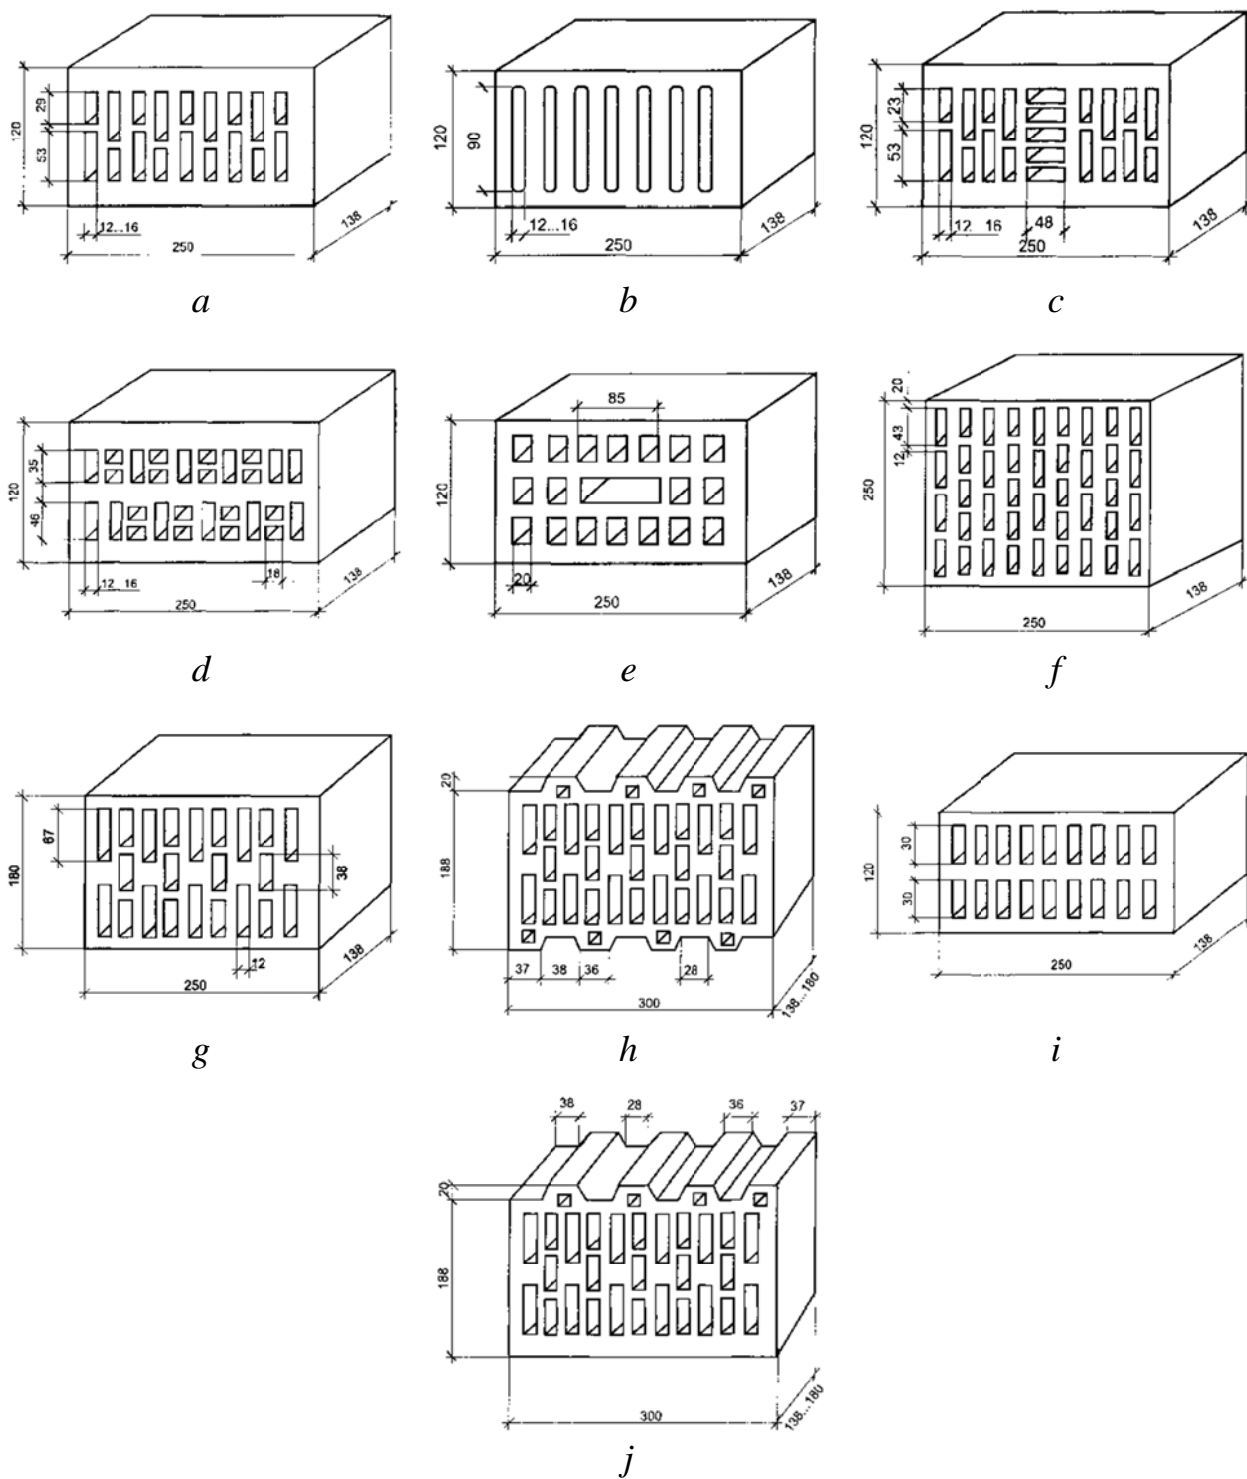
Камни с пустотами квадратной, прямоугольной и неправильной формы:
